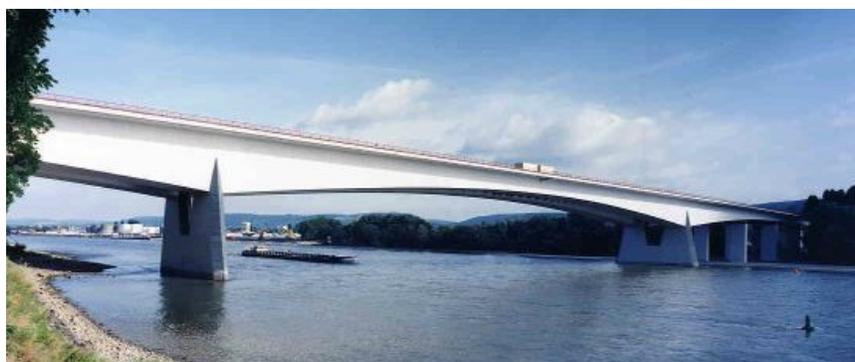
Puente sobre el Rhin, Bendorf, Alemania.
